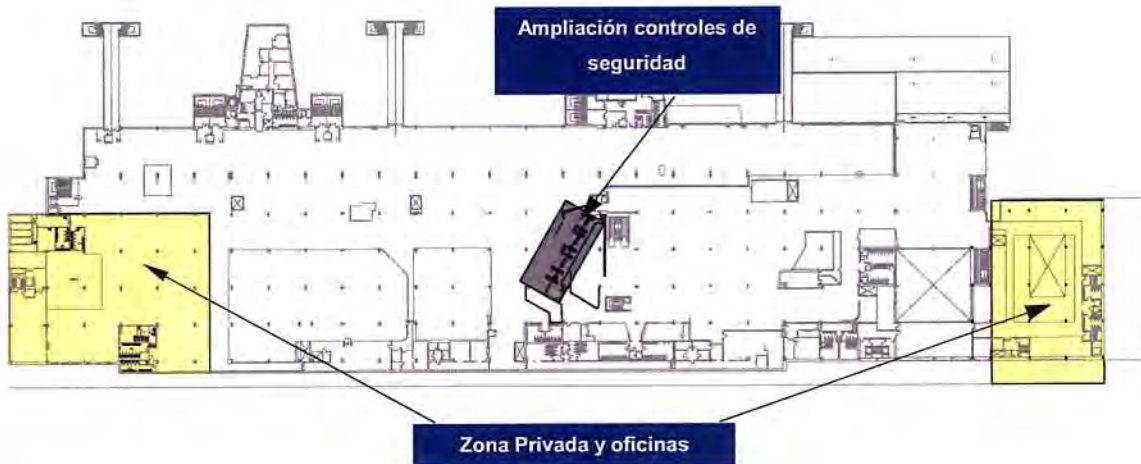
Alternativa 1 de Edificio Terminal. Planta Primera
